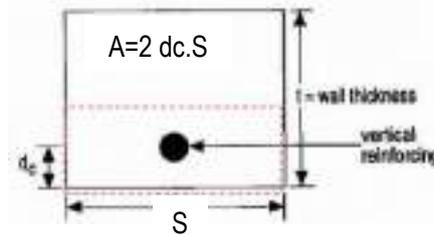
Área efectiva de tensión del concreto para el cálculo de Z (Project, 2006)
